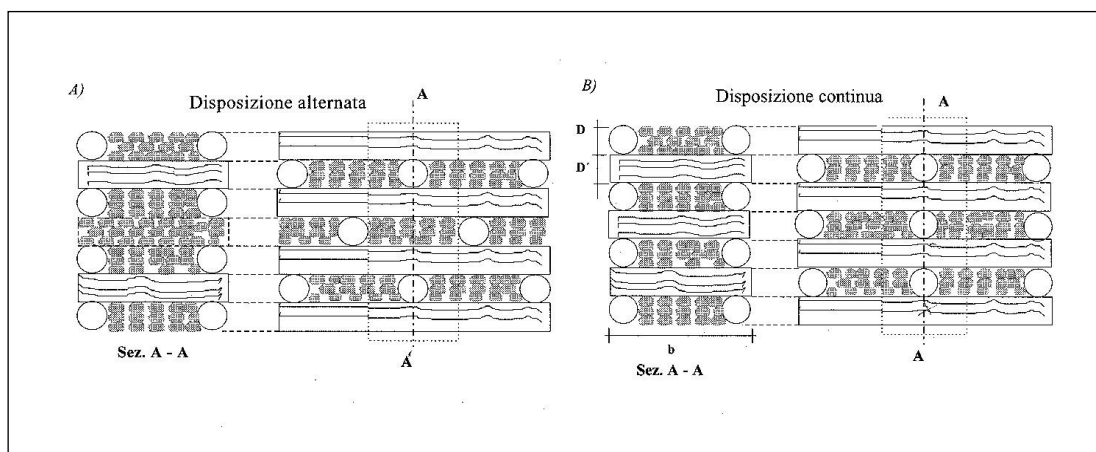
Disposizione alternata e continua degli elementi trasversali della briglia in legname e pietrame.
